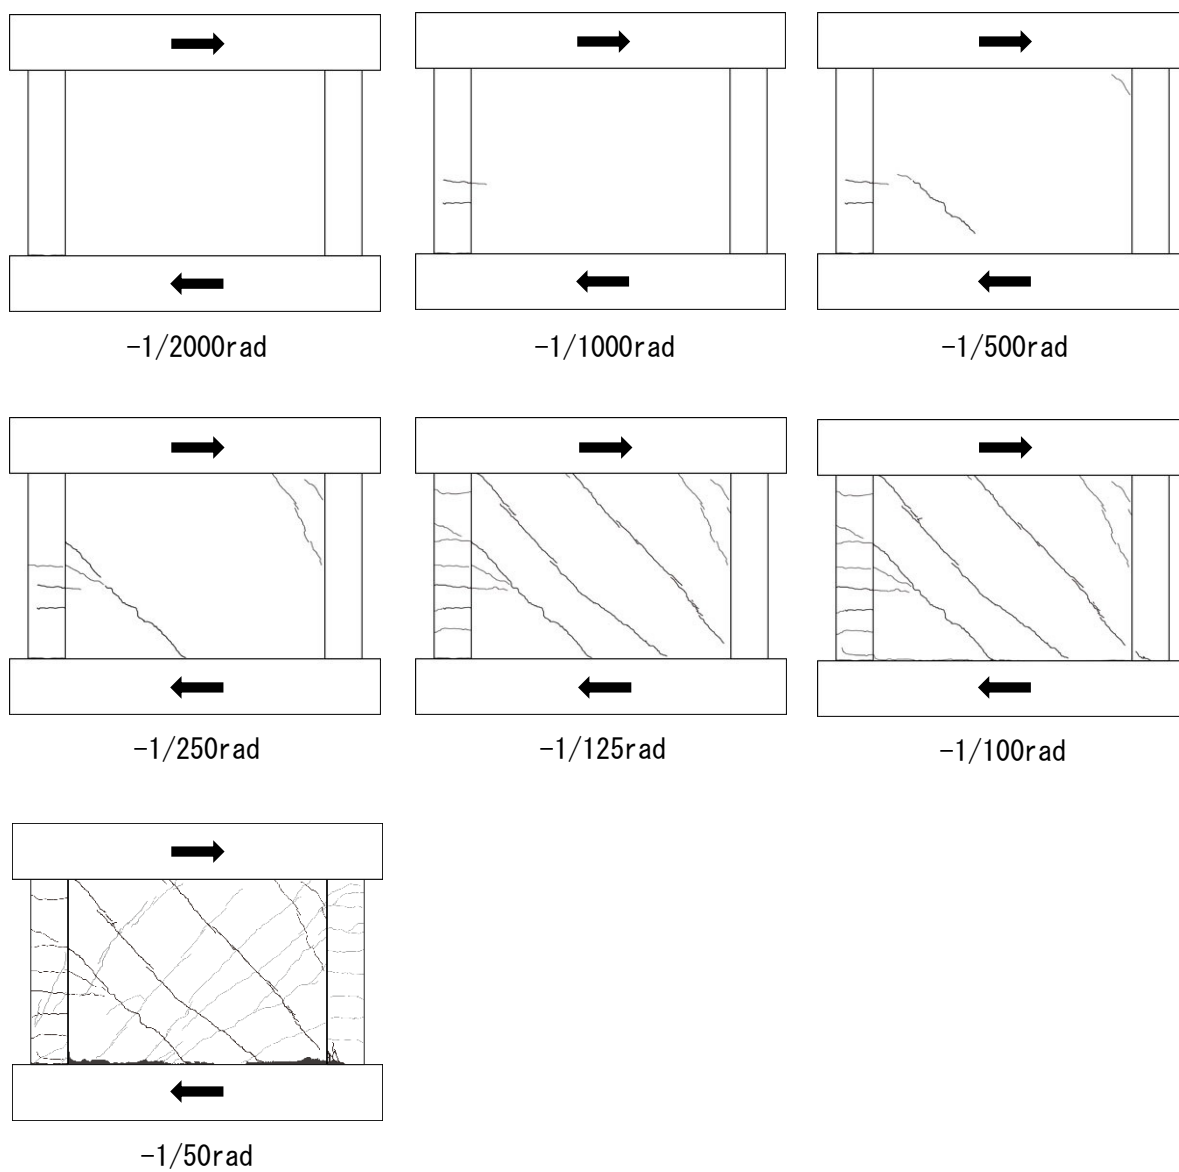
各層間変形角のひび割れ状況図 (F21-W-1.5) (続き)
